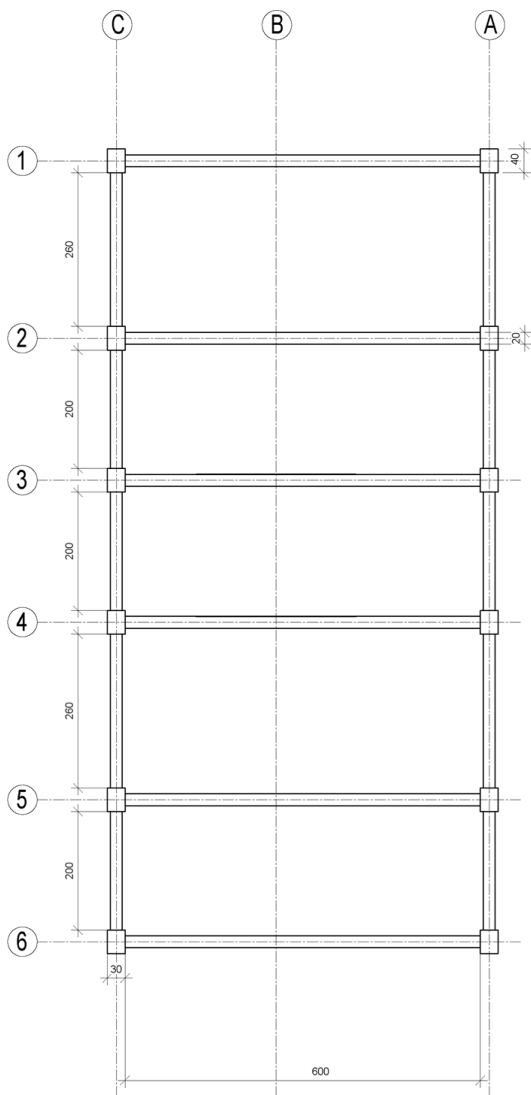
Planta de Arquitectura primer prototipo chile. Elaboración Propia.
